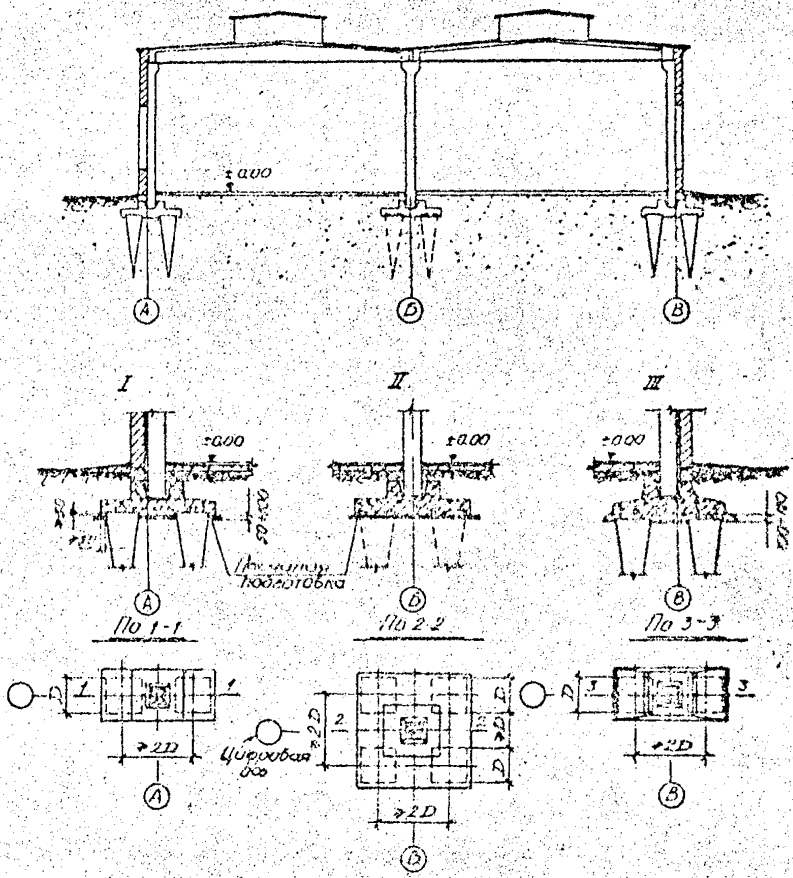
Применение пирамидальных свай в основании промышленного здания. I, II—монолитные железобетонные ростверки; III—сборный ростверк.
